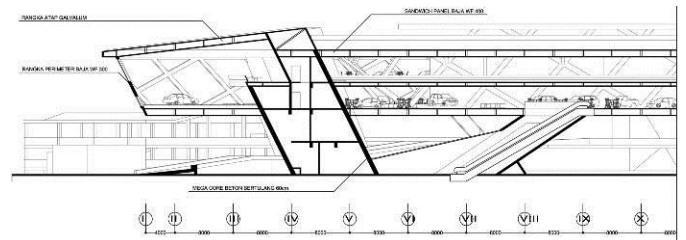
Sistem penyaluran beban keseluruhan bangunan
